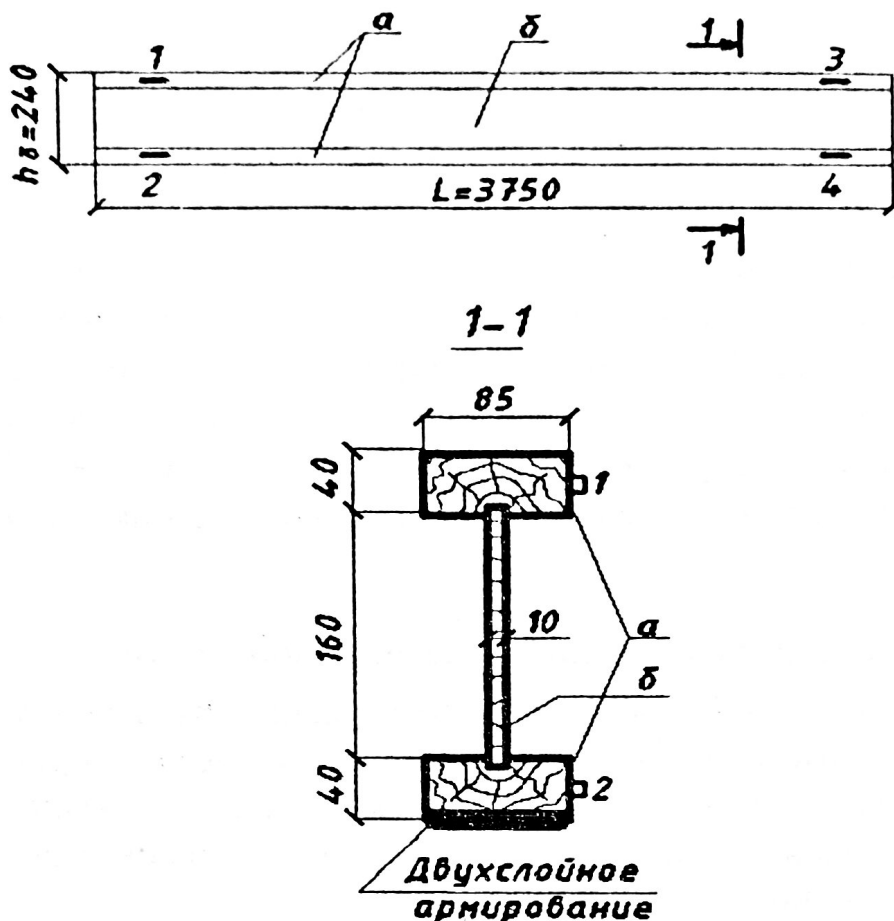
Схема расположения тензодатчиков на балке и армирование поясов.
